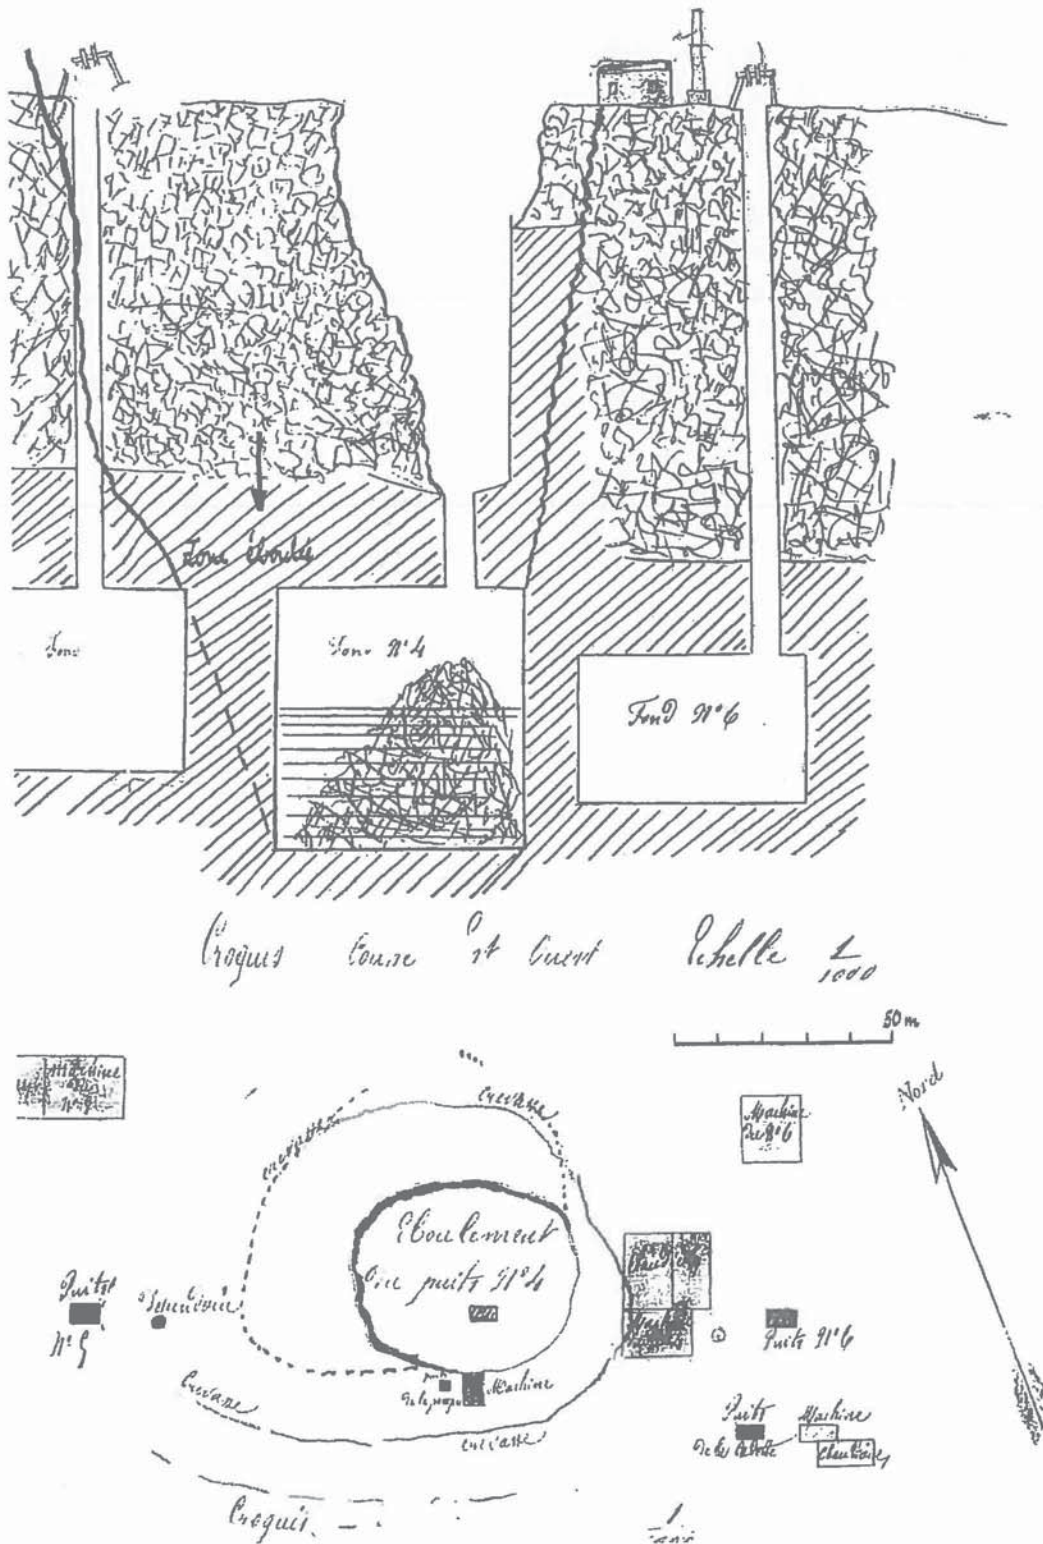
Effondrement du fond n° 4 de La Papeterie en 1887
